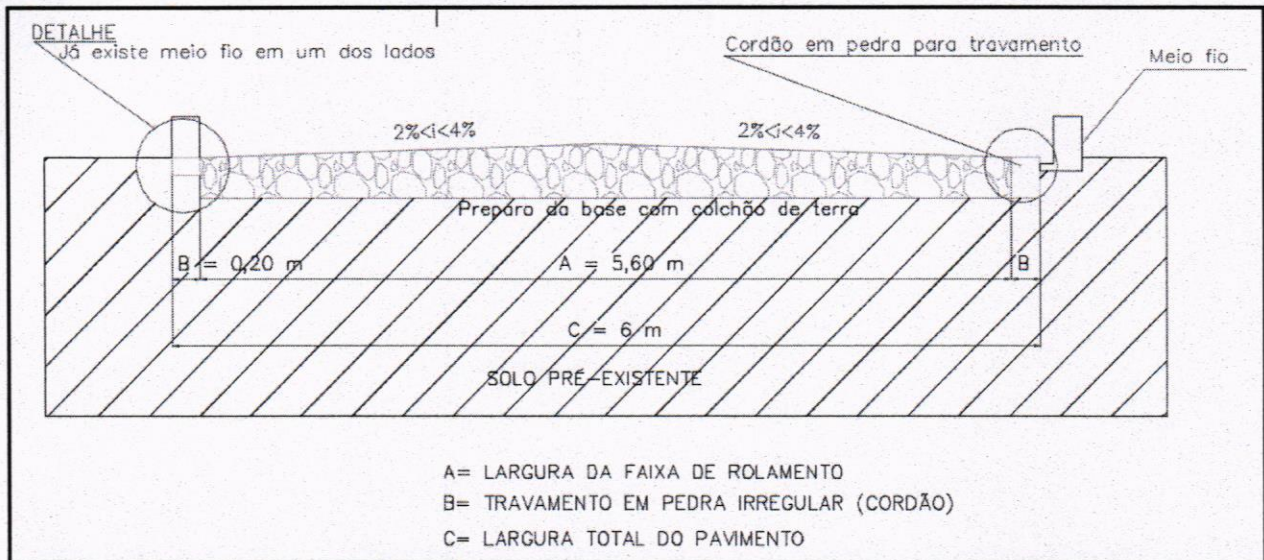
Detalhe em corte transversal do Pavimento - Genérico
